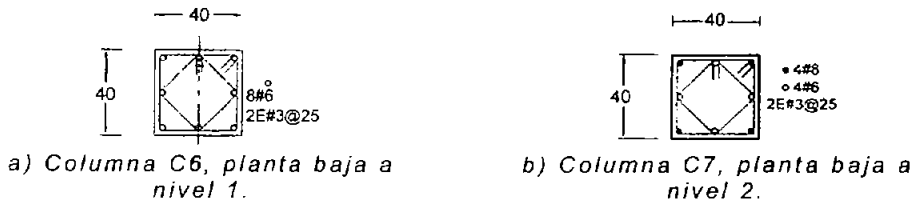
Columnas C6 y C7, dimensiones en cm (Planos de plantas tipo, 2001).
